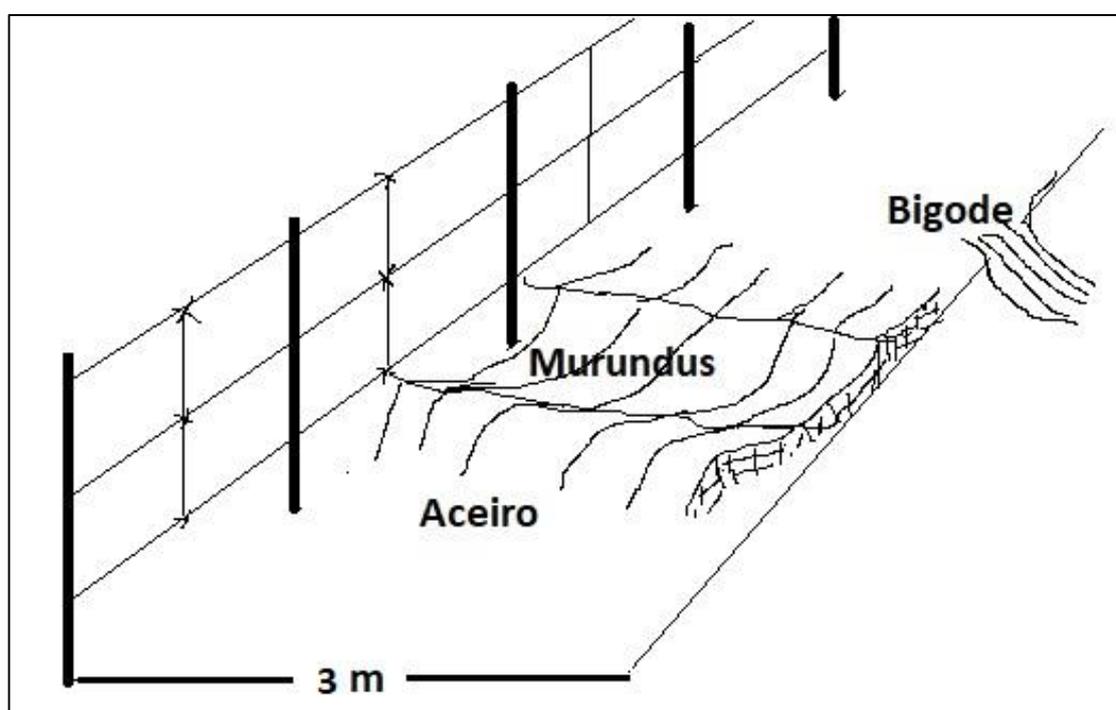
Desenho esquemático do aceiro e estruturas de controle da erosão (sem escala)
